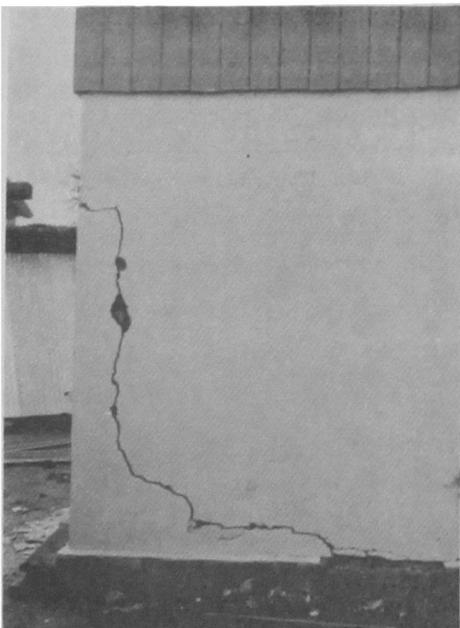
Grieta en unión de pilar con muro de albañilería. Casa de la Municipalidad de Osorno. (Véase Fig. 38).
